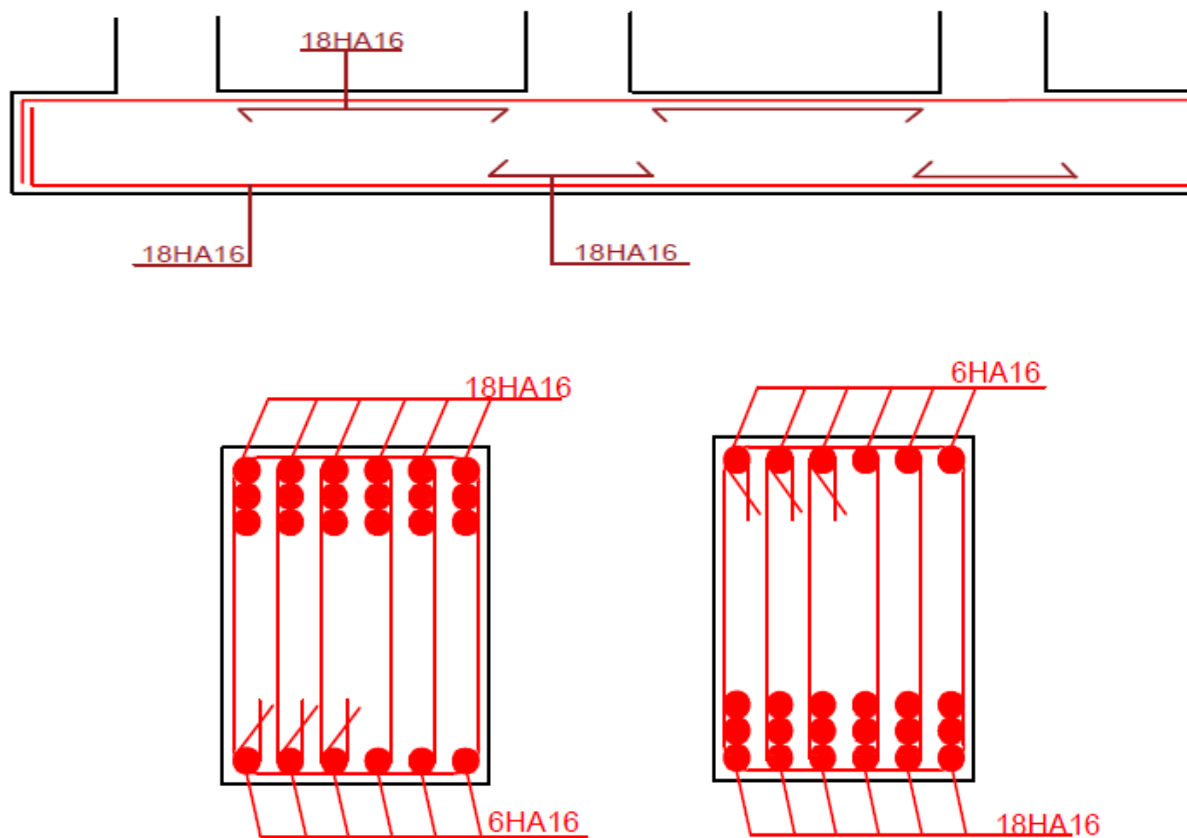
Schéma de ferrailage de la poutre de rigidité.
